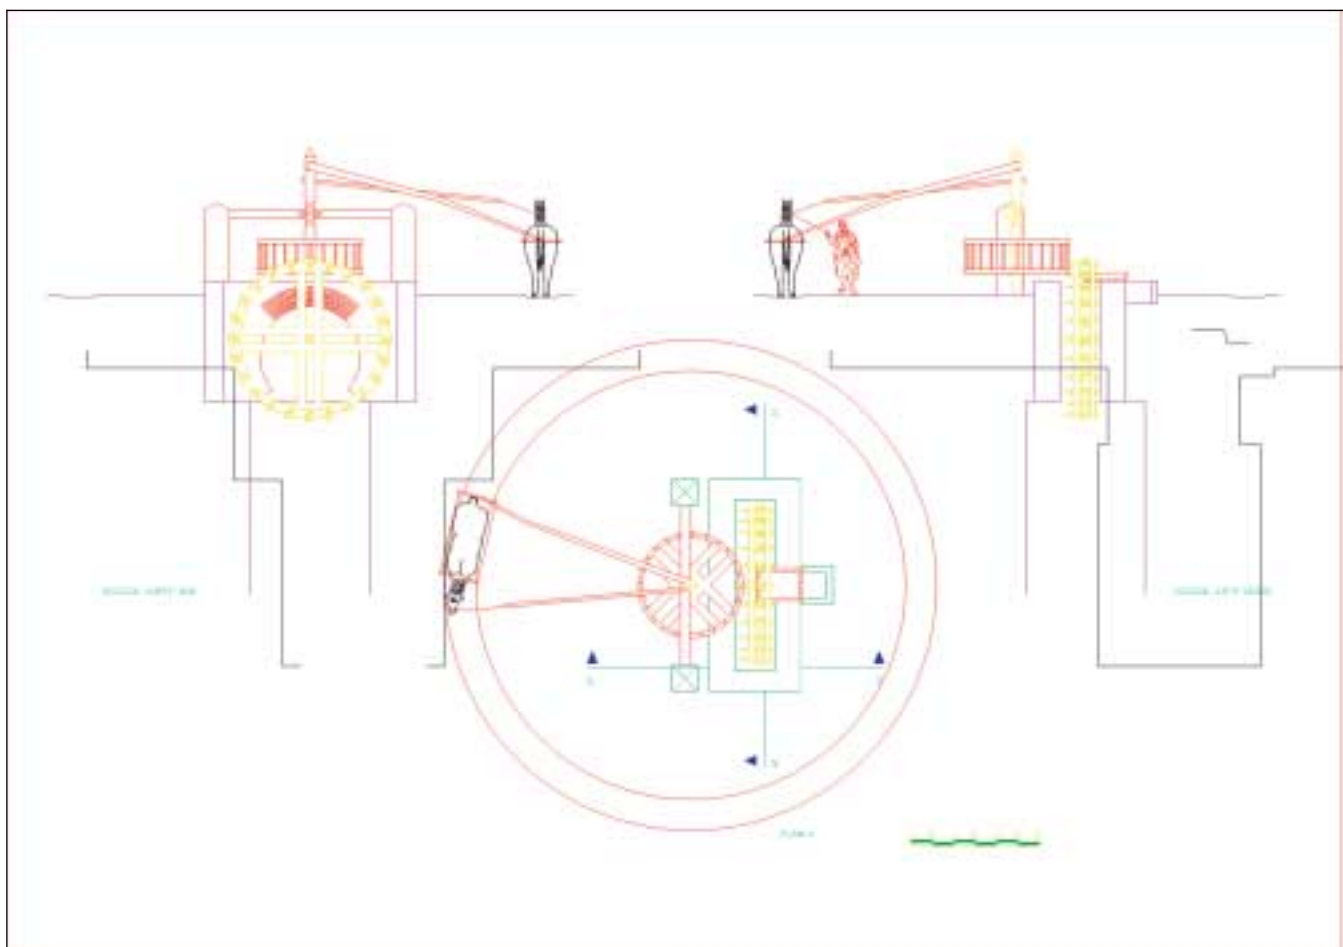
Reconstrucción hipotética de la noria. Planta y secciones.
